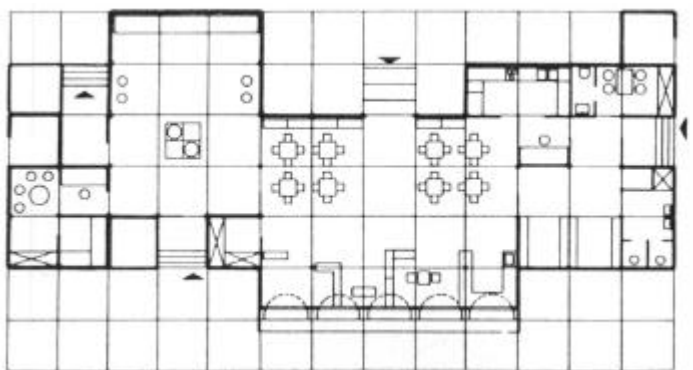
Kindergarten der Stadt Wien, Grundriß ²
